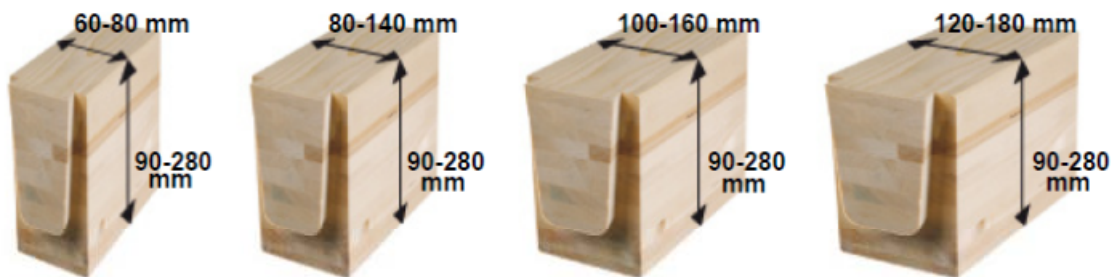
Forma de la espiga mecanizada mediante las plantillas ARUNDA (www.arunda.ch)
